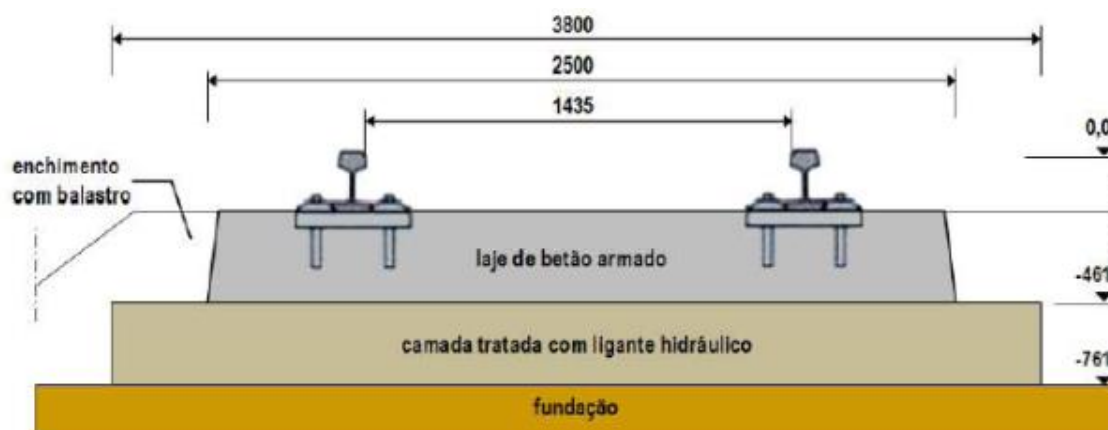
Perfil transversal esquemático da solução BES Heilit & Woerner (Paixão & Fortunato, 2009)
